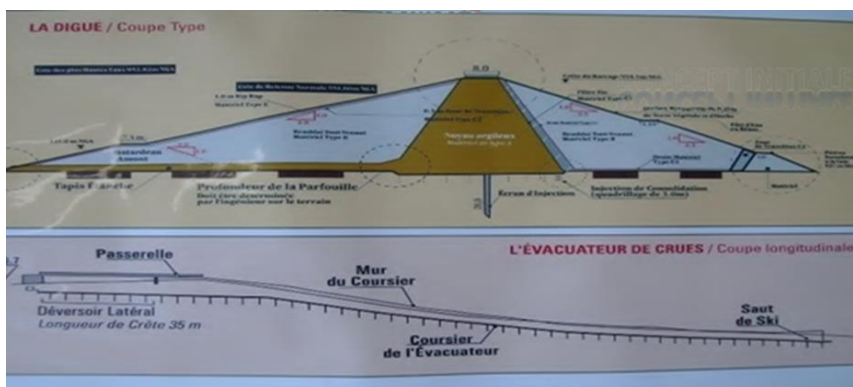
digue principale et coupe en travers du barrage d'Ourkiss (Présentation du barrage d'Ourkiss,2011).
